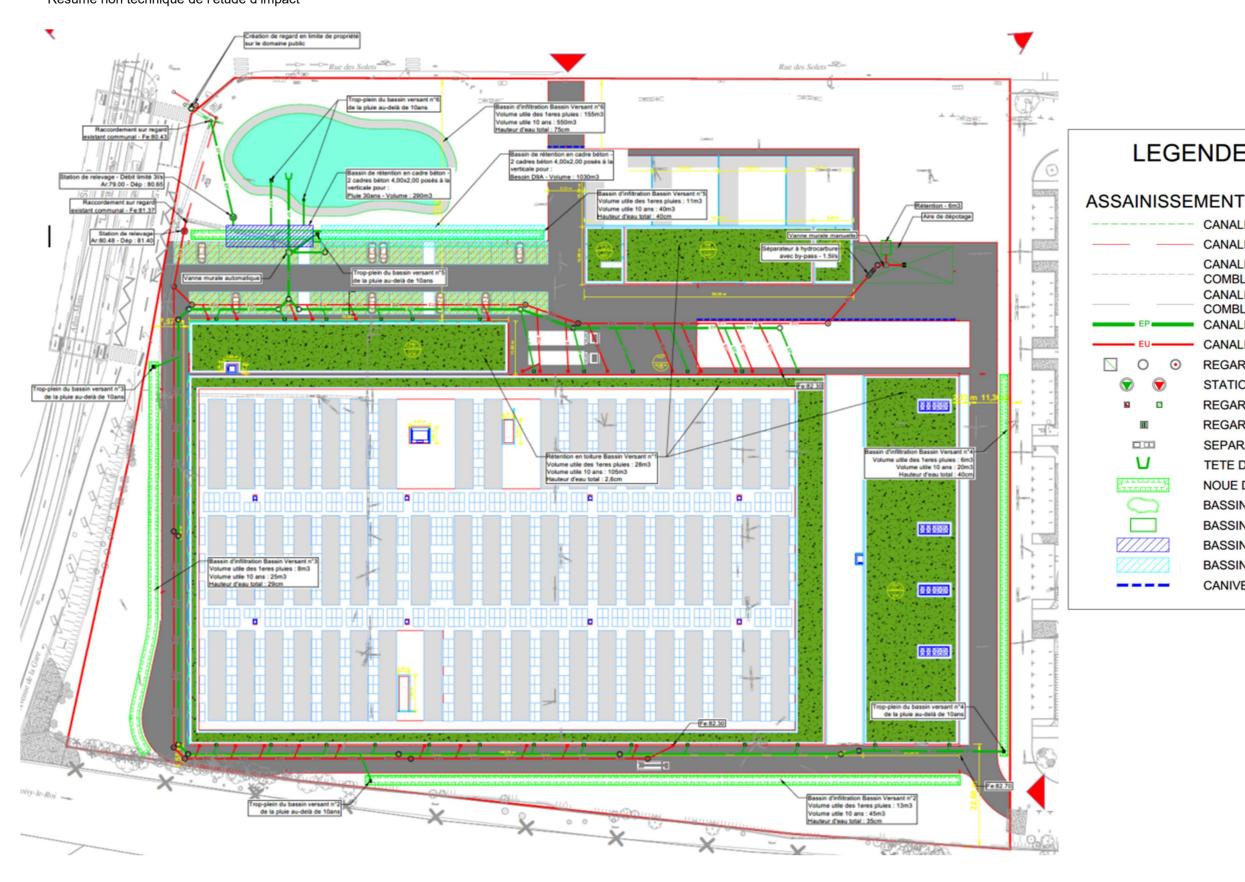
Plan de l'assainissement prévu sur le site du projet (source : CL Infra)
